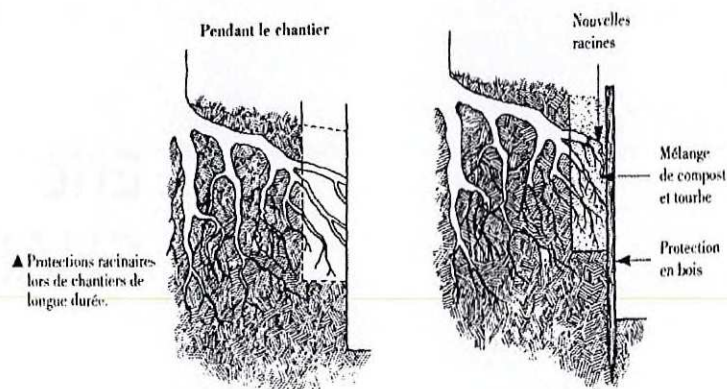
exemple de protection des racines en cas d'ouverture d'une tranchée
